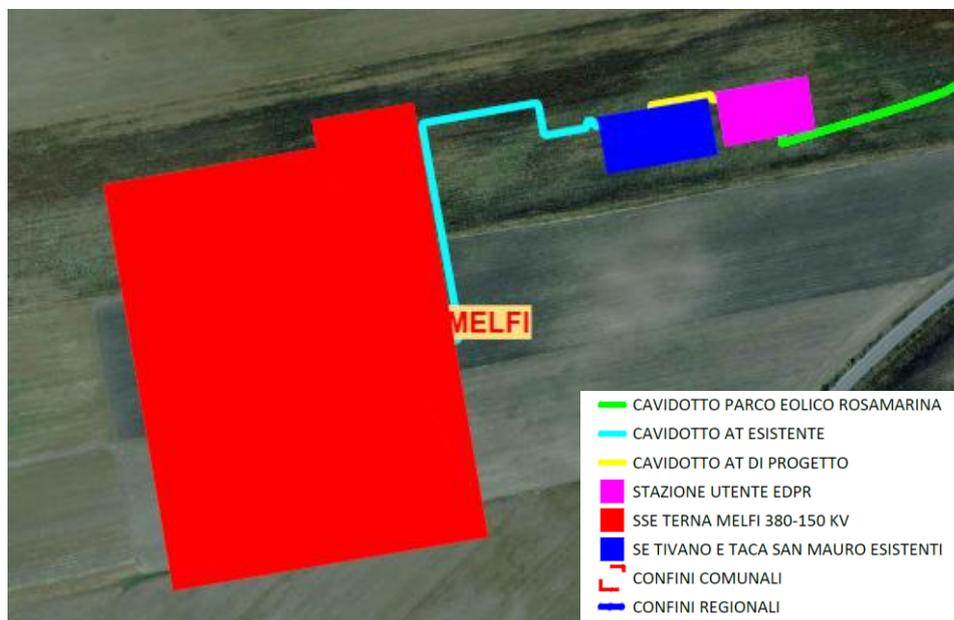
Stralcio planimetrico area sottostazione nel territorio comunale di Melfi in Località Masseria Catapaniello
